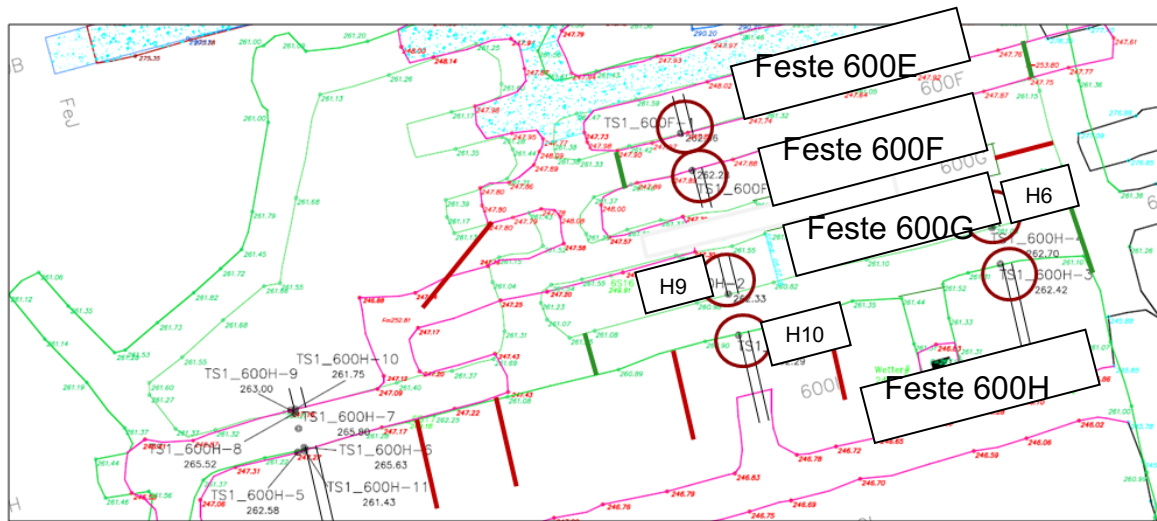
Grubenplan Bergbau Breitenau inklusive durchgeführter Kernbohrungen und Extensometermessungen
